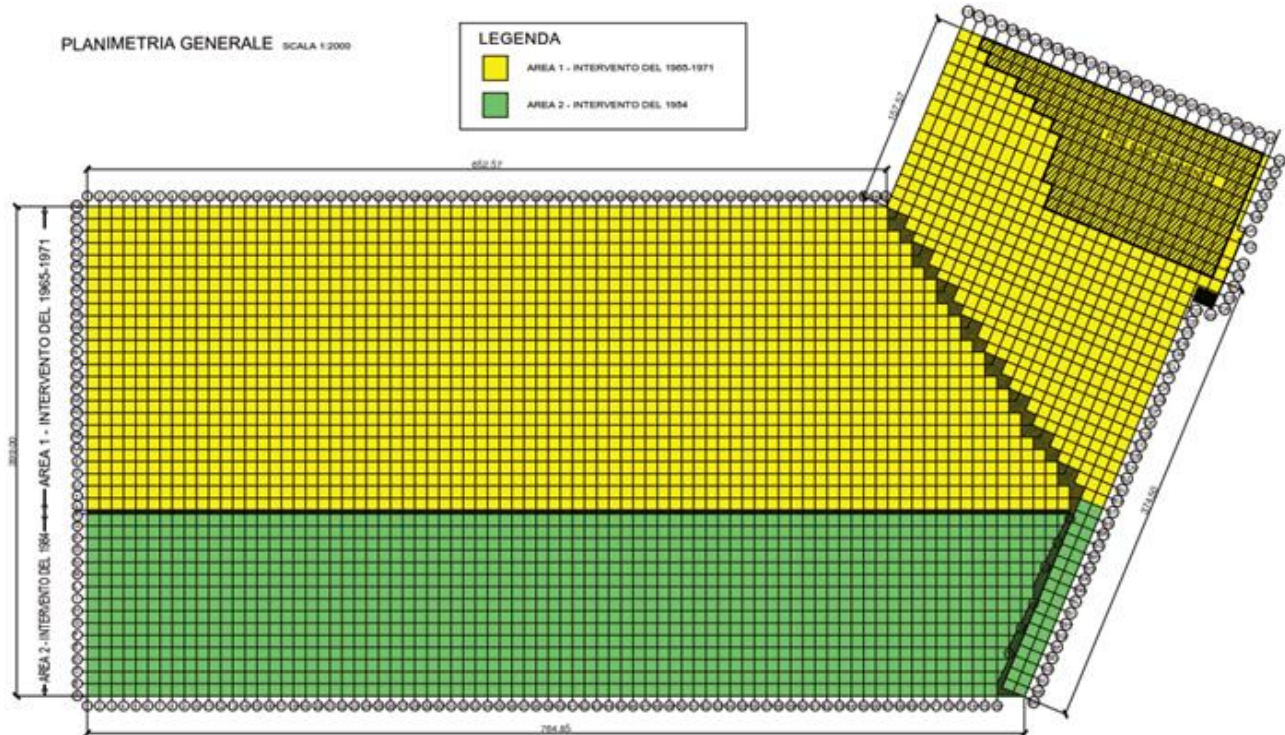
Planimetria delle piastre prefabbricate con indicazione del periodo di realizzazione
